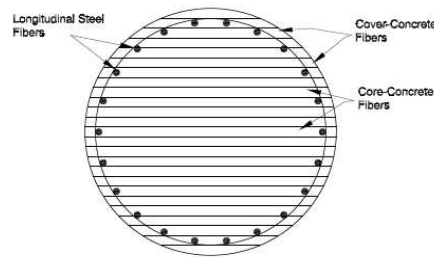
Rappresentazione della modellazione a fibre di una sezione circolare
